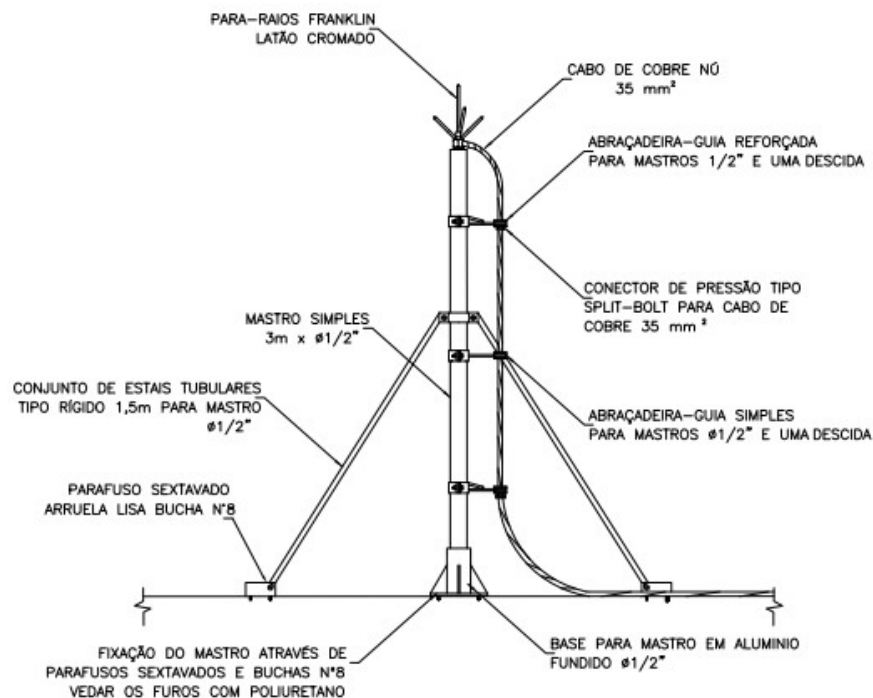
Exemplo construtivo da Gaiola de Faraday em edificações deste subitem.
